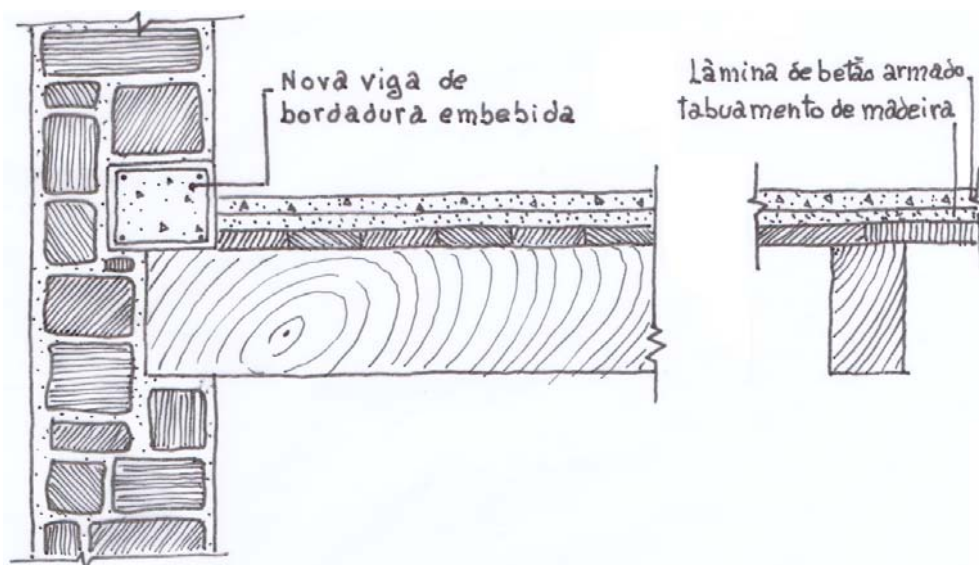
| Rigidificação do pavimento de madeira interligado a parede resistente, por colocação de lâmina argamassada armada, acima do pavimento, encastrada em viga de cintagem embebida na alvenaria (adaptado de [14]):
